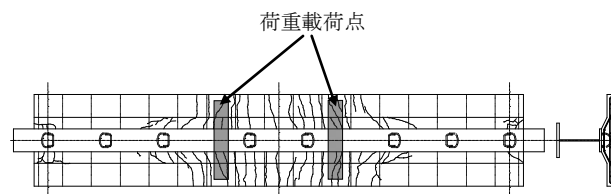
床版下面最終ひび割れ状況(軽量コンクリート)
